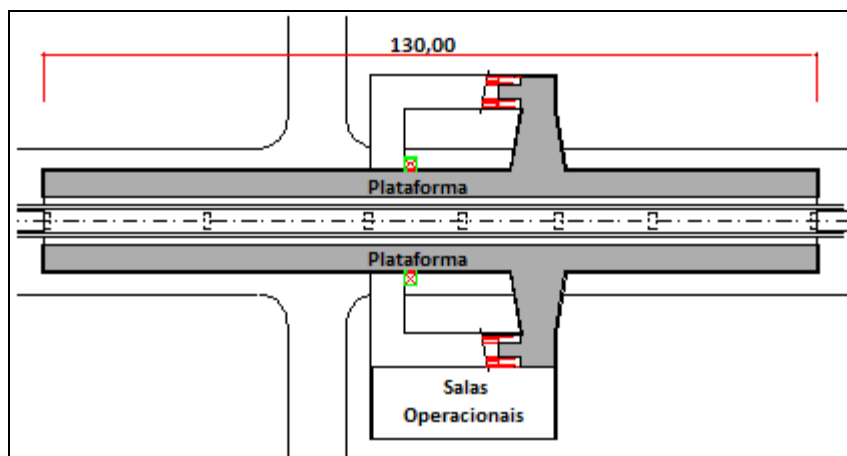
ESTAÇÃO ELEVADA
